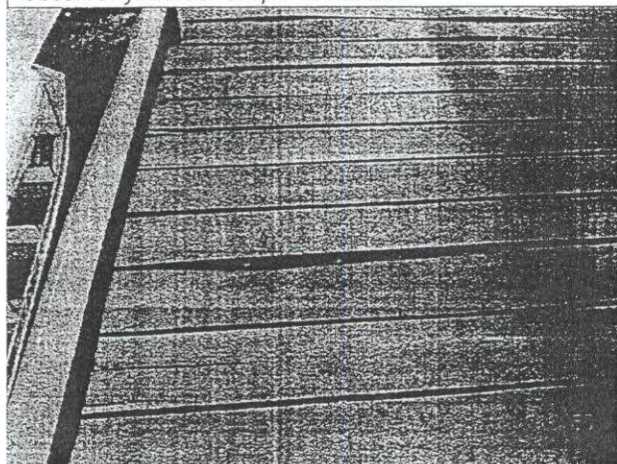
Madeiramento do assoalho do pier com empenamentos
